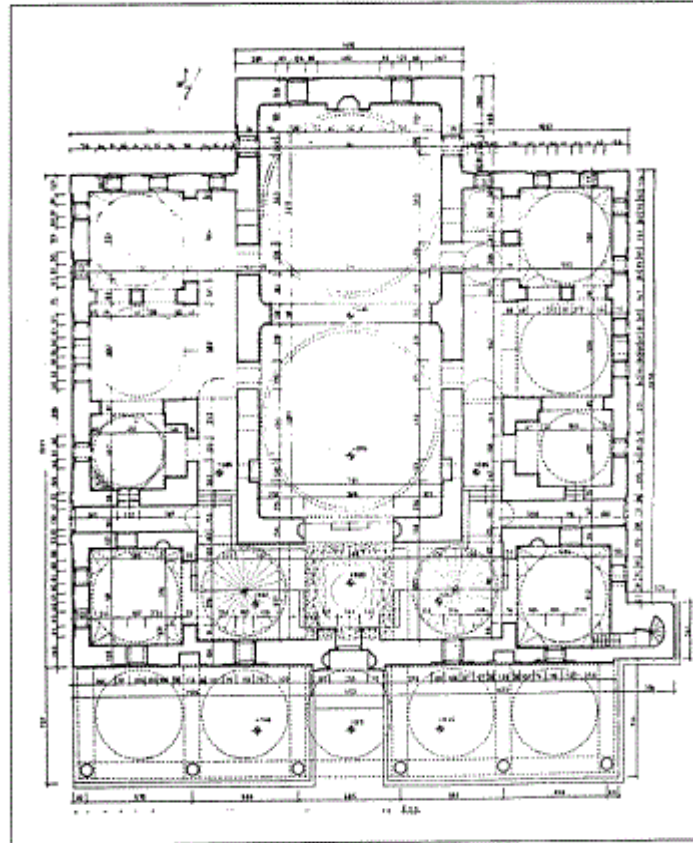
مسقط أفقي لمسجد عيسى بك في أسكوب (عن: إيفردي).
